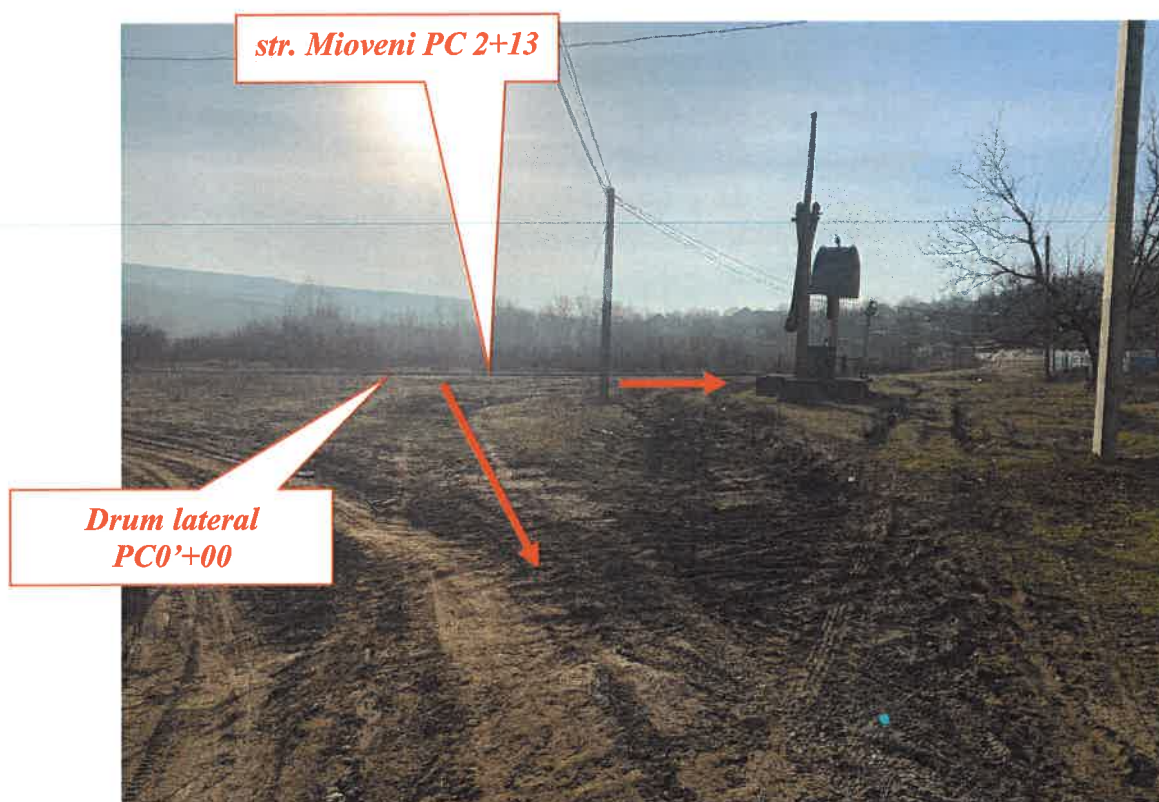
Situatia existanta la drum lateral PC0'+00 (conexiunea cu str.Mioveni la PC2+13)
